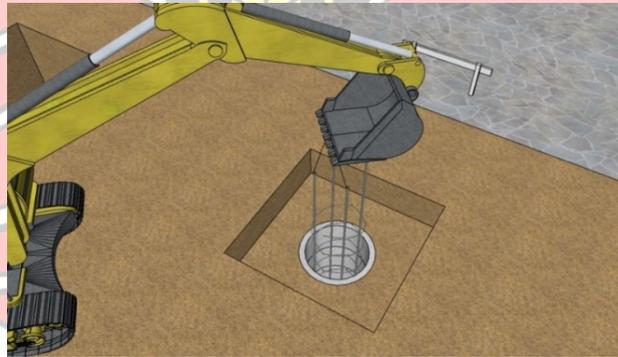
24 Detail reinforcement steel cage / Penulangan
